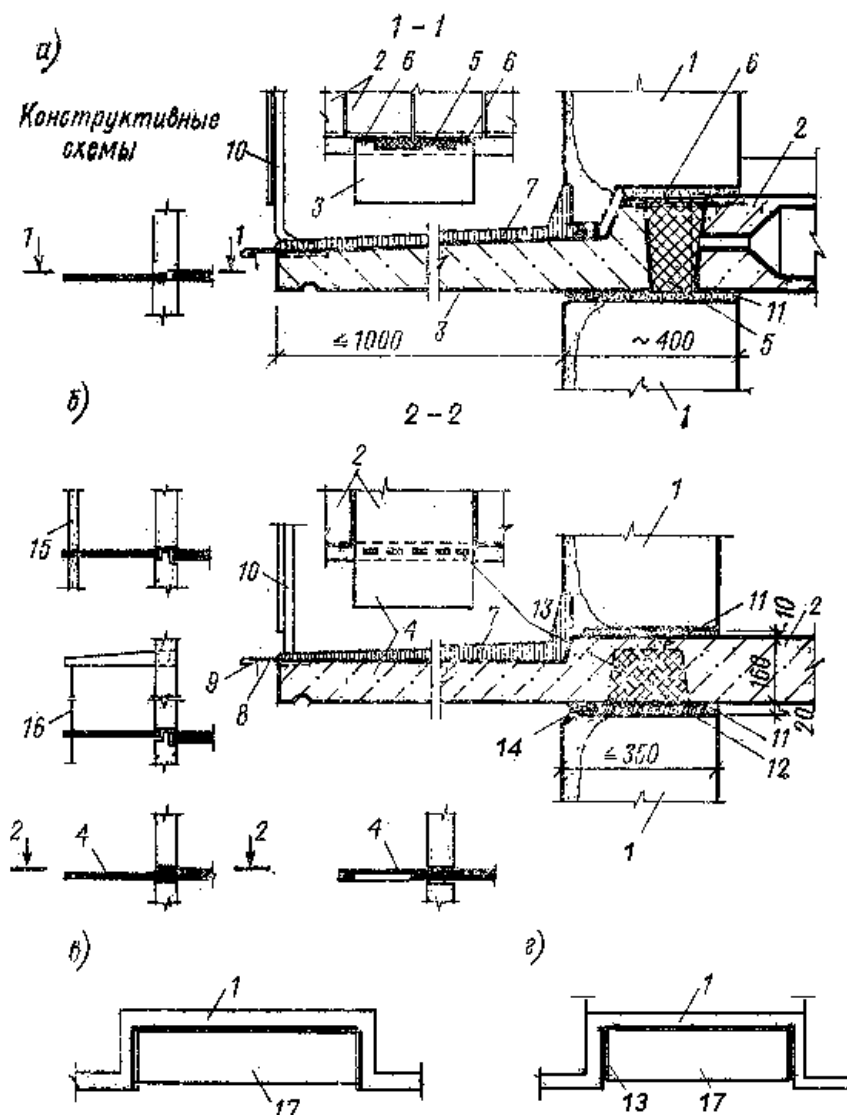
Конструкции балконов и лоджий. а, в – при несущих наружных стенах, б, г – при навесных стенах, 1- наружная стеновая панель, 2 – панель перекрытия, 3 – плита балкона, 3 – консольный выпуск панели перекрытия, 5 – утеплитель, 6 – анкерующая связь, 7 – литой асфальт, 8 – костыль, 9 – оцинкованная сталь, 10 – ограждения балкона, 11 – раствор. 12 – конопатка, 13 – гнезда, заполненные эффективным утеплителем, 14 – герметик, 15 – стойка, 16 – тяж, 17 – плита лоджии, 18 – дополнительные железобетонные стенки лоджии.
